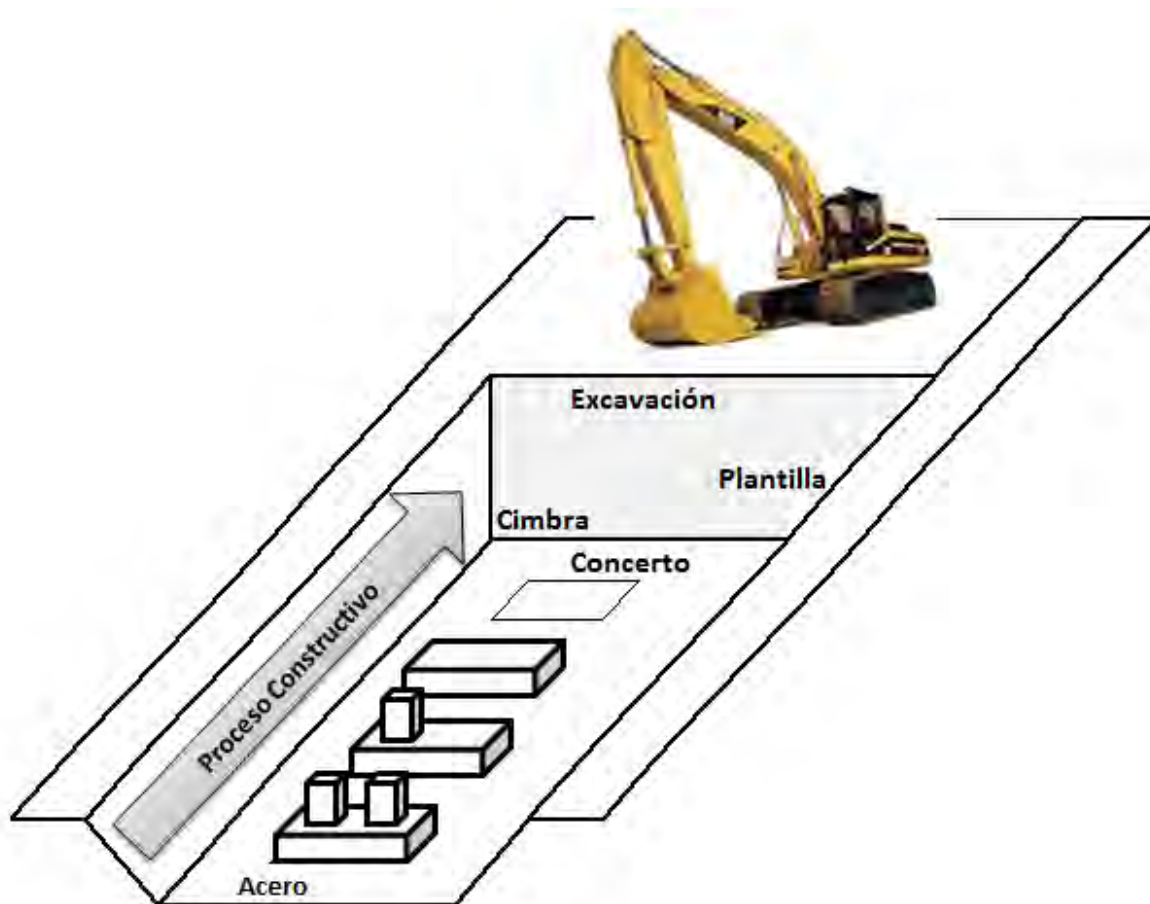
Apertura para las actividades de plantilla, cimbra, acero y concreto
